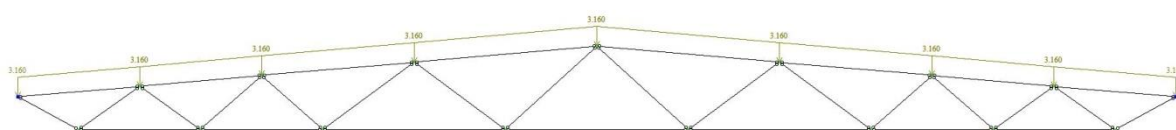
Расчетная схема фермы с нагрузкой от веса кровли
